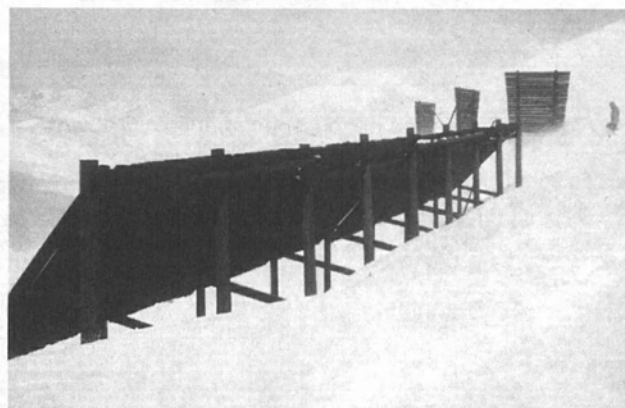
Toit-buse avec, en arrière plan, des râteliers paravalanches.
